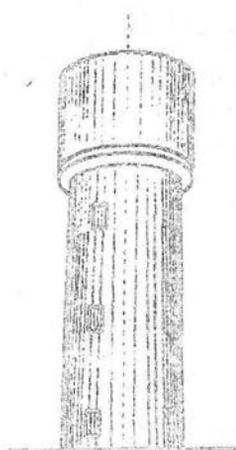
Tanque elevado cilíndrico de concreto con subestructura cilíndrica
